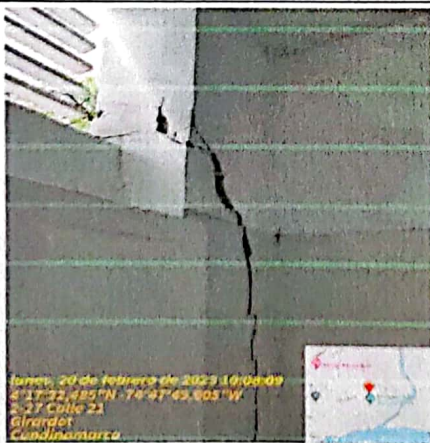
Grietas que atraviesan el espesor de pared
